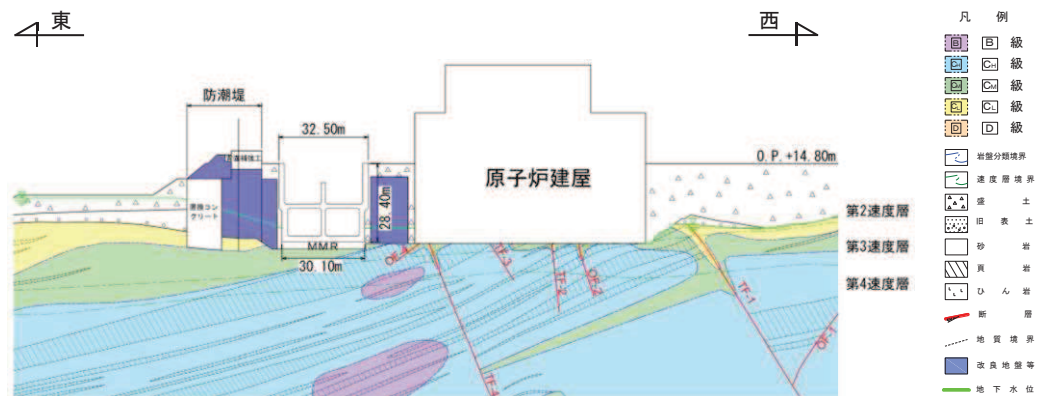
海水ポンプ室 地震時荷重算出用地質断面図
